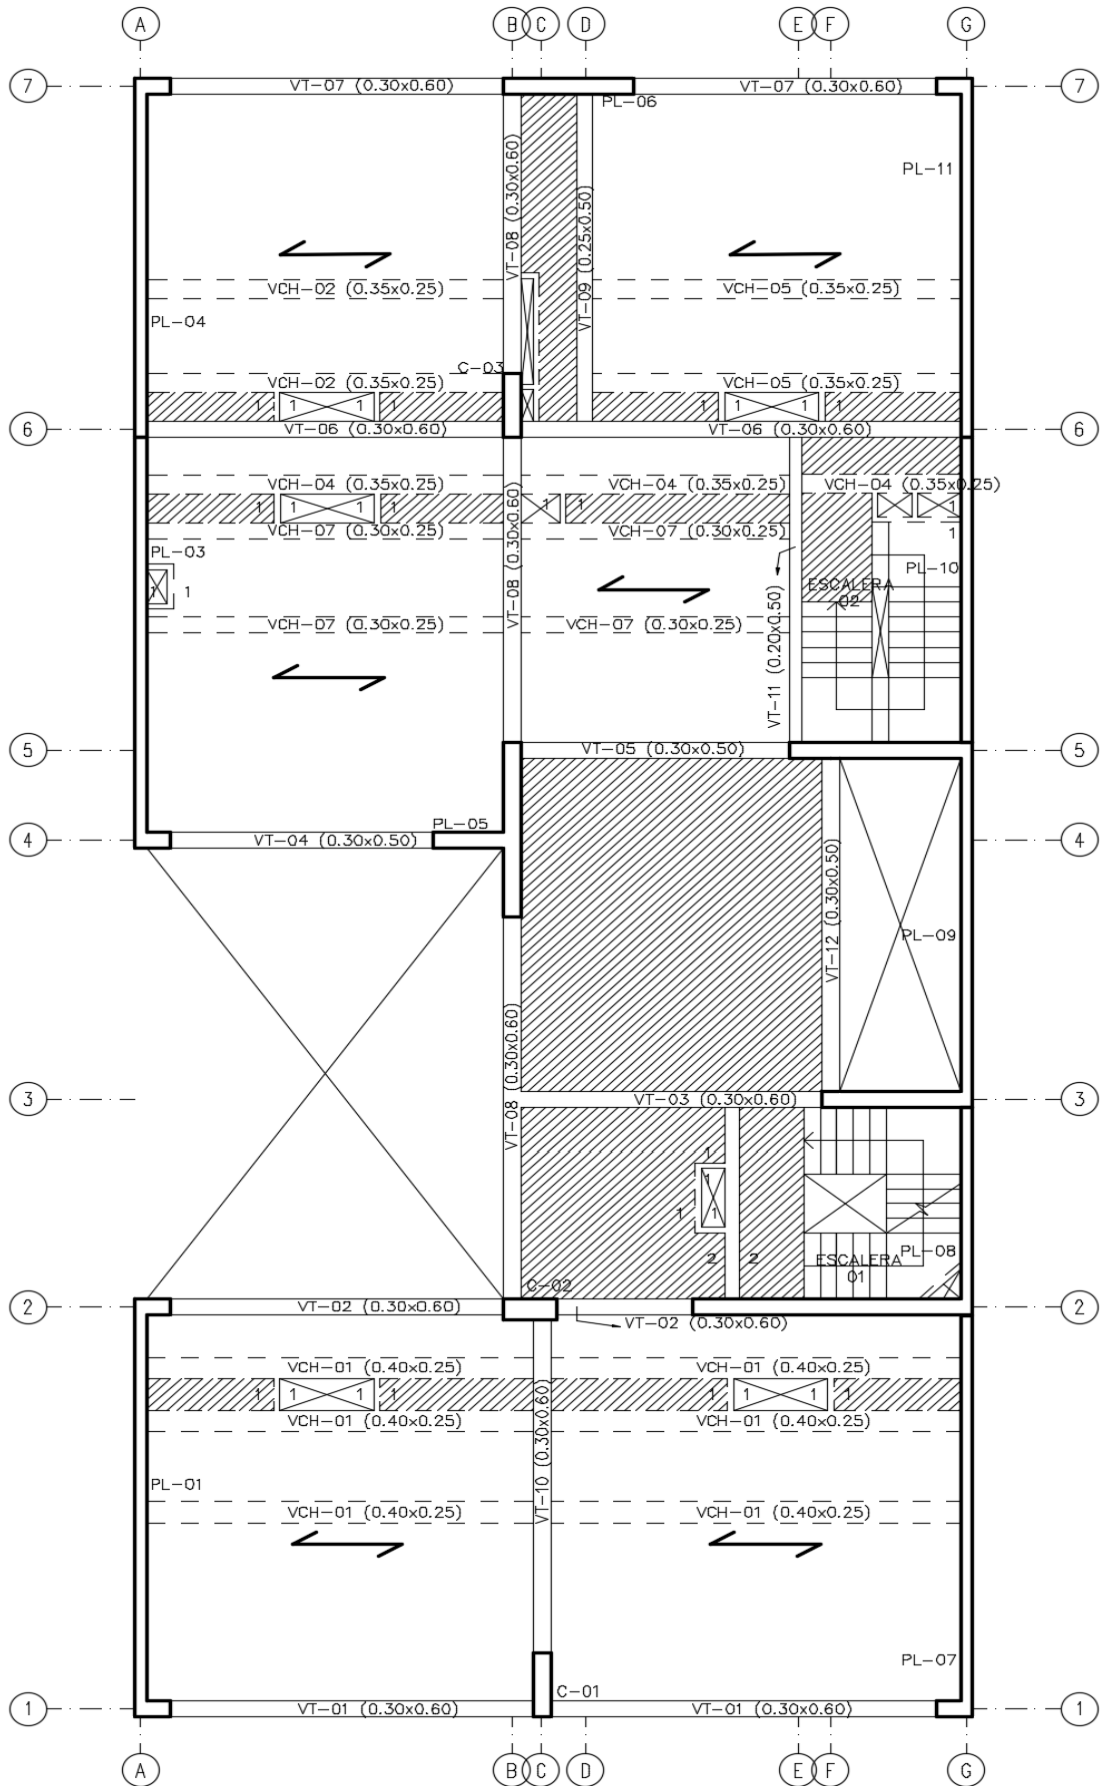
Estructuración del piso típico (3er al 6to piso).
